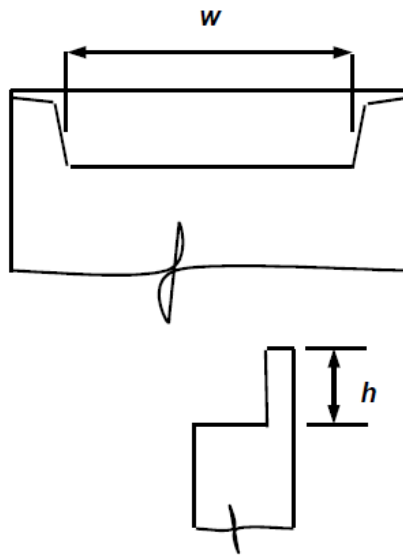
Ancho y altura del muro pantalla que intervienen en el cálculo de la rigidez del estribo.
